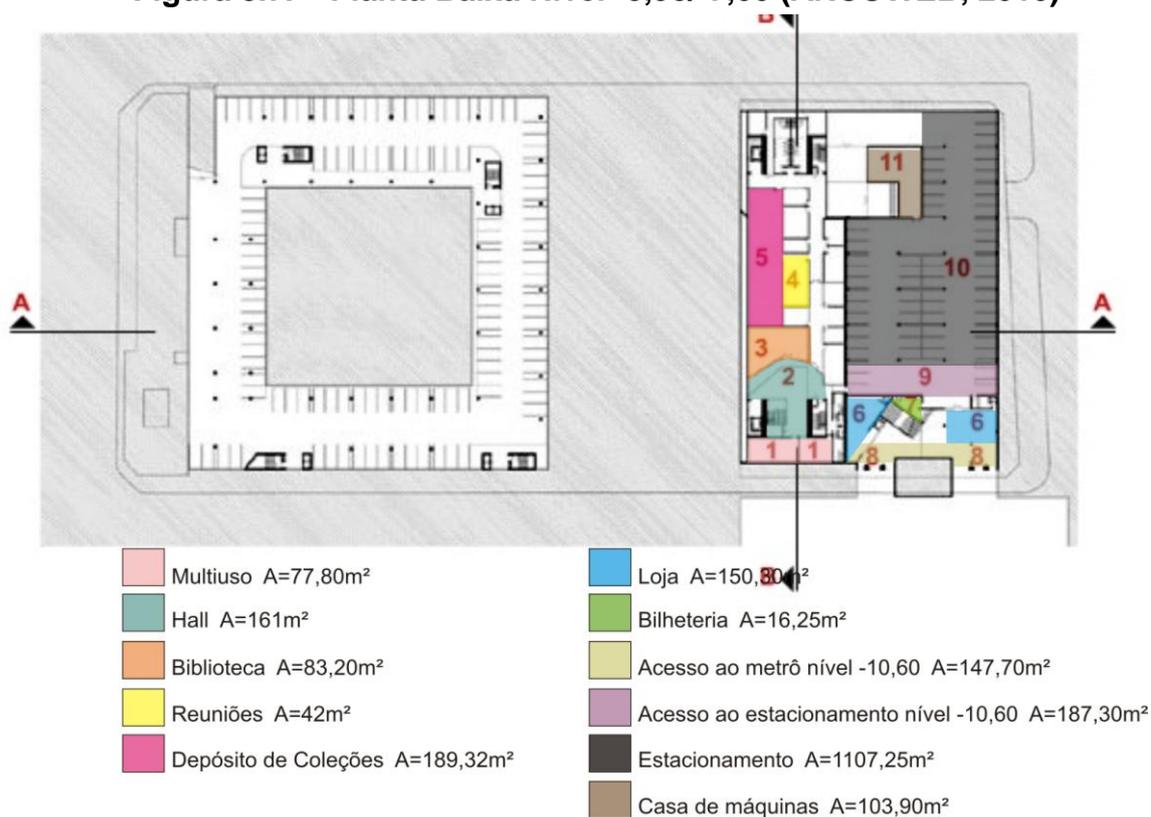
Planta Baixa Nível -10,61/-10,71 (ARCOWEB, 2010)
